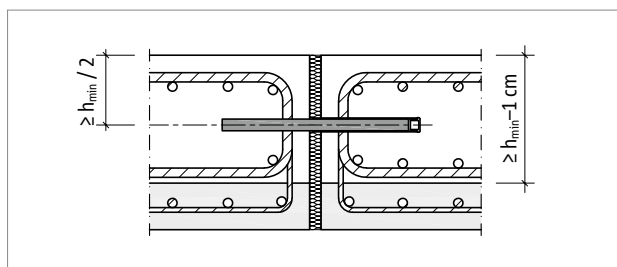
Schöck Stacon® Typ LD: Anordnung bauseitige Bewehrung in Halbfertigteilplatten
